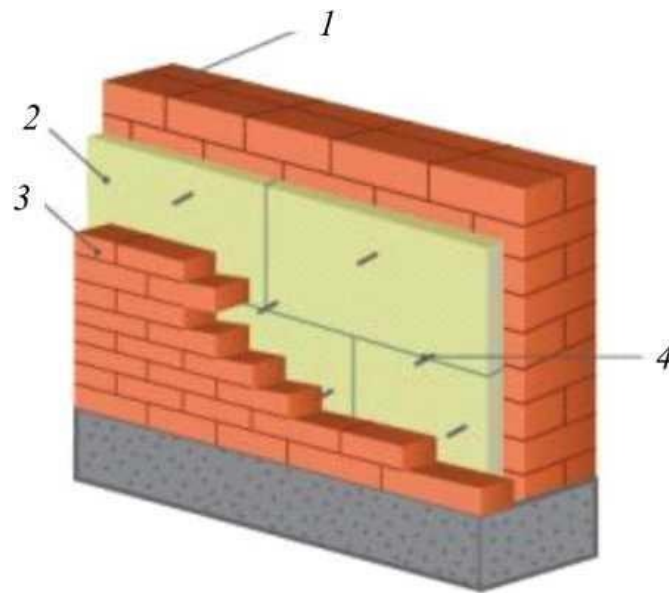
Конструкція шаруватої кладки:
